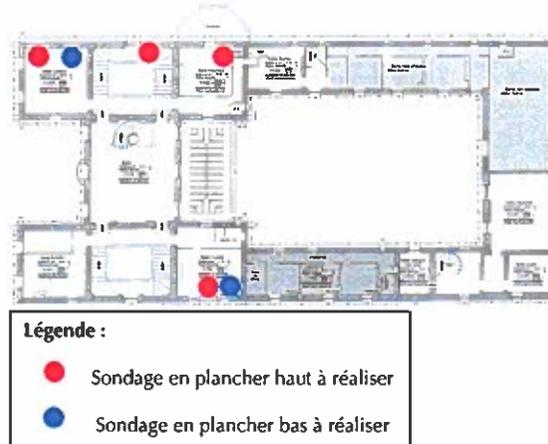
Plan du premier étage, sondages structurels à prévoir
